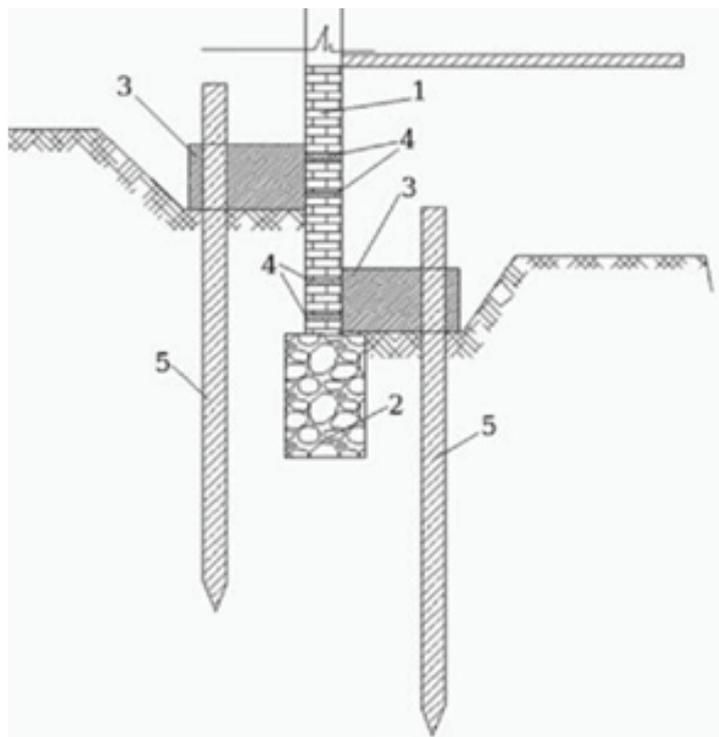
Схема усиления фундамента задавливаемыми сваями:
